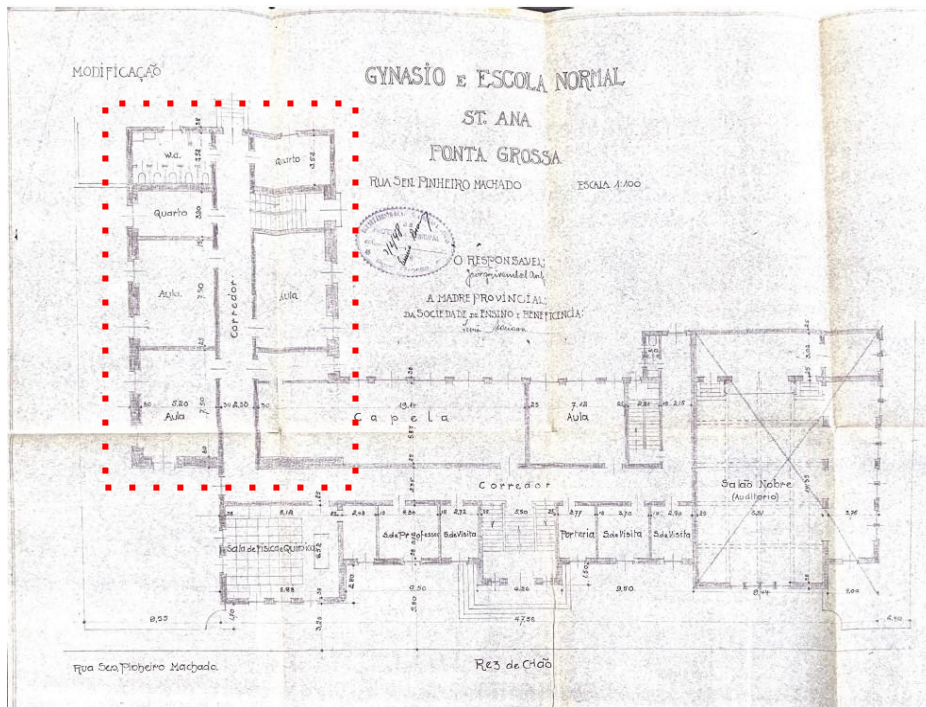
Planta do pavimento térreo. Fonte: Casa da Memória, 2022
